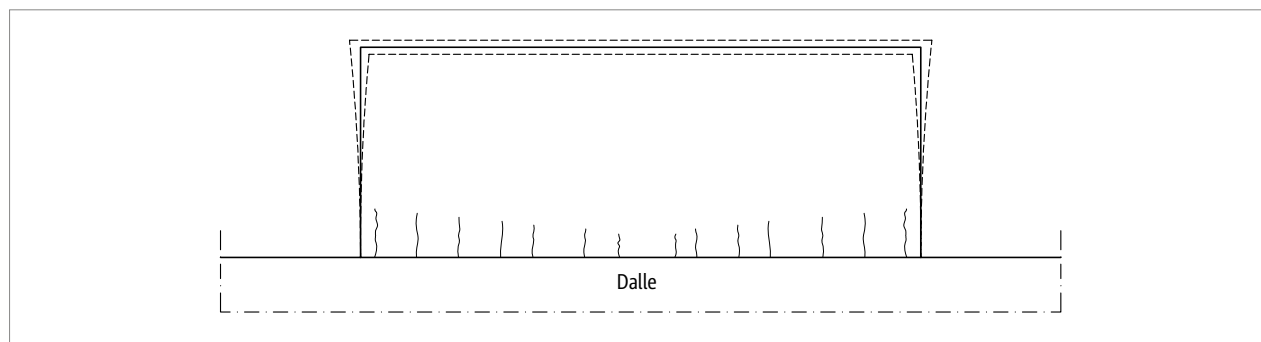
Dalle de balcon sans élément Schöck Isokorb® : Fissuration possible due à la fatigue
